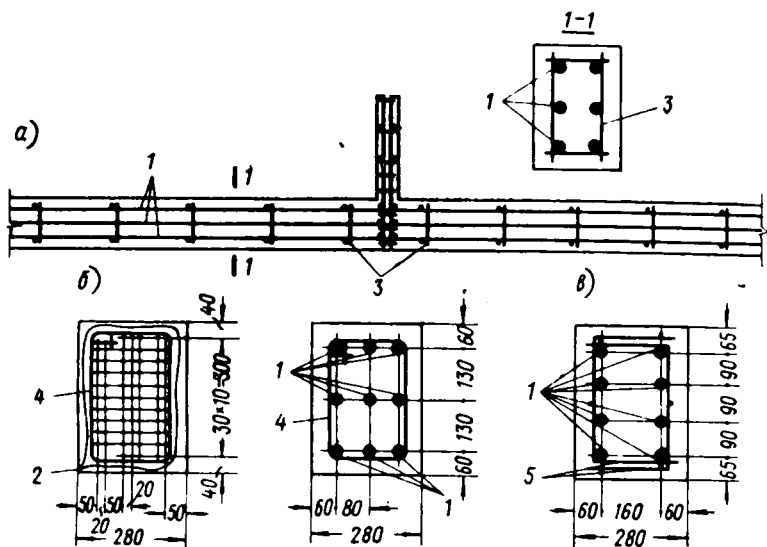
Схема установки арматуры в нижних поясах ферм
